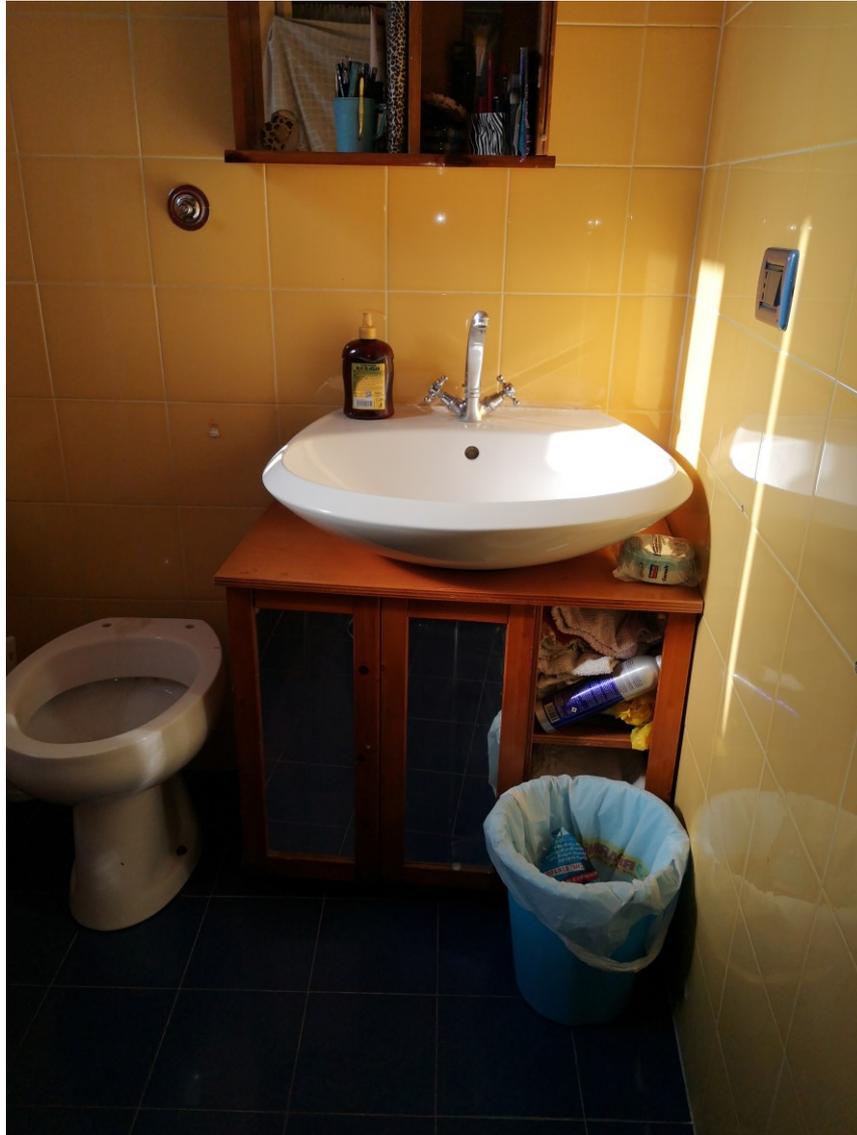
Particolare del lavabo del Wc posto al piano secondo.
